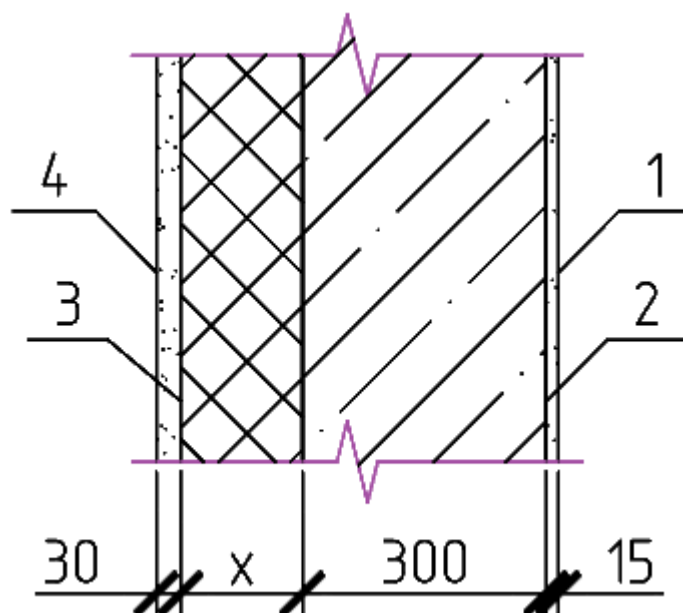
Схема конструкции стены с железобетоном.
